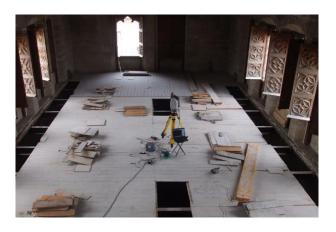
ESCÁNER LÁSER 3D trabajando en la planta primera del Consulado del Mar. Fuente propia.
